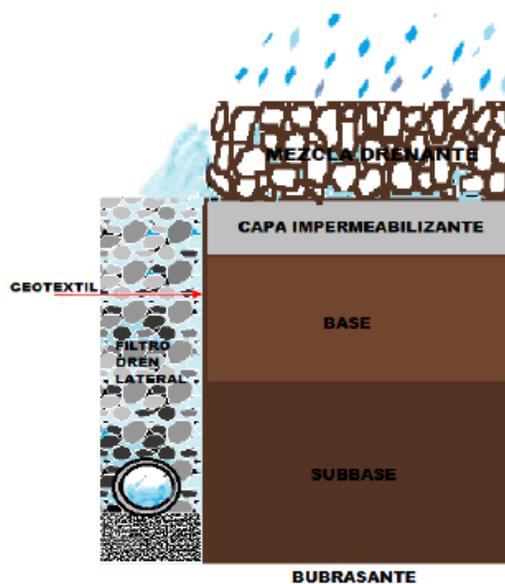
Estructura de pavimento poroso recomendada por la Asociación de Pavimento de Asfalto de Arkansas
